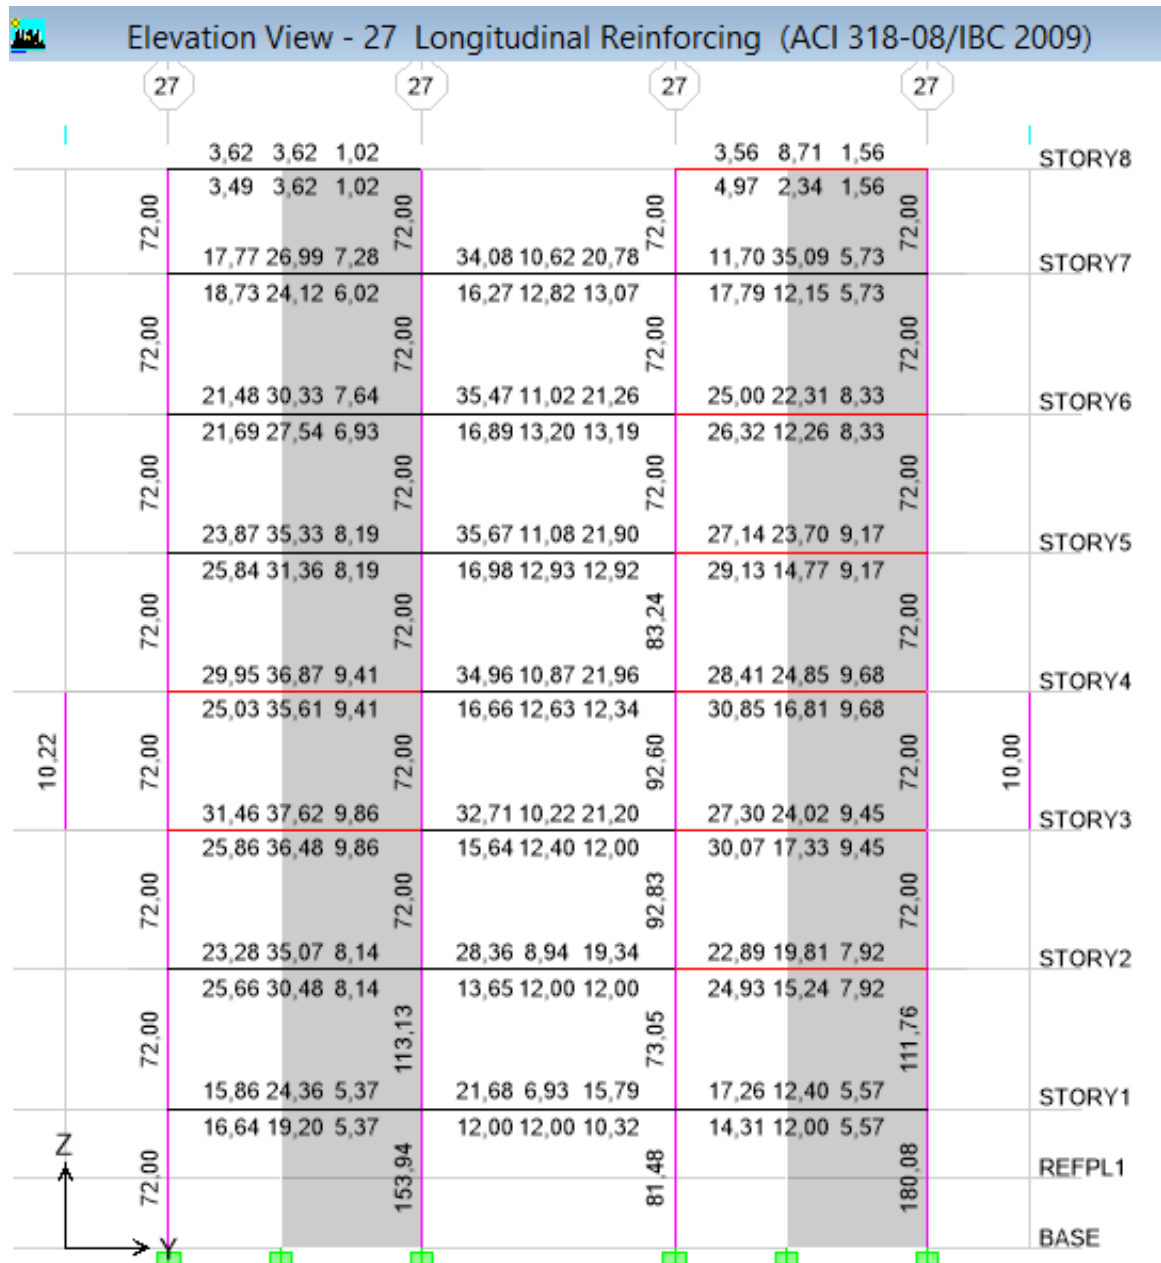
Acero en Vigas y Columnas en el Pórtico 27 – Hospitalización 2- (CEC-2002)
